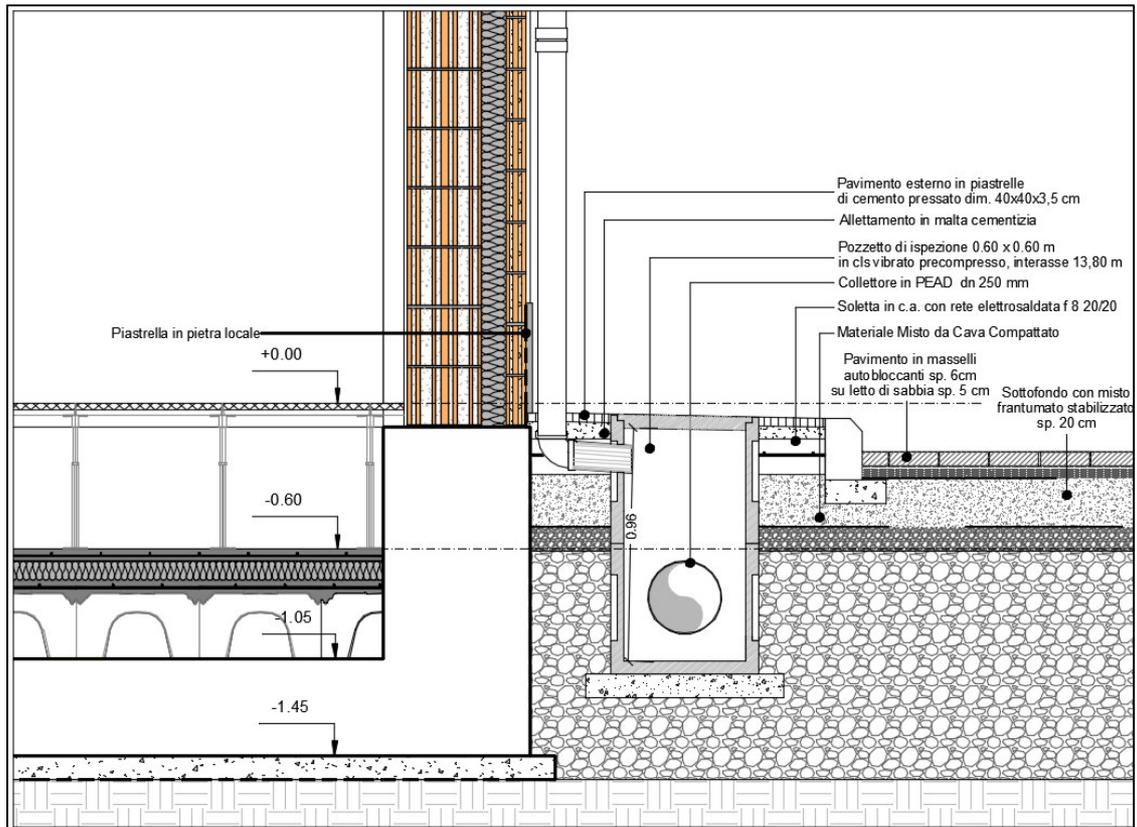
Dettaglio collegamento pluviale-pozzetto
